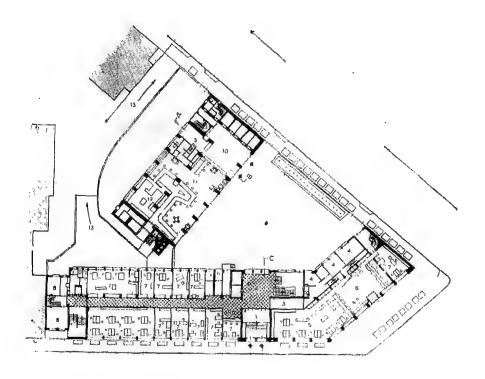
٣٨ - ٦ : مسقط أفقى الدور المتكرر - الزوجى.
